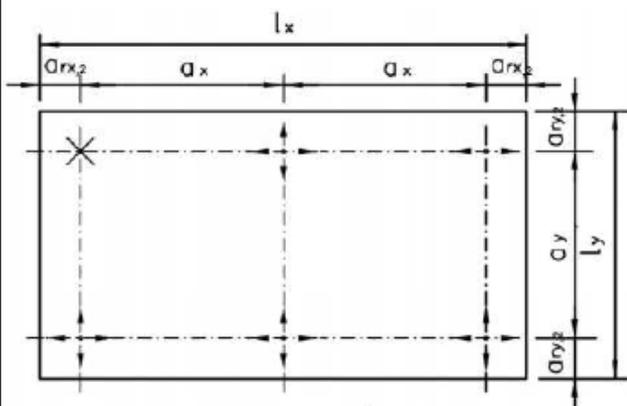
Fassadenplatte mit 6 Agraffen – Lagerungsart 3
